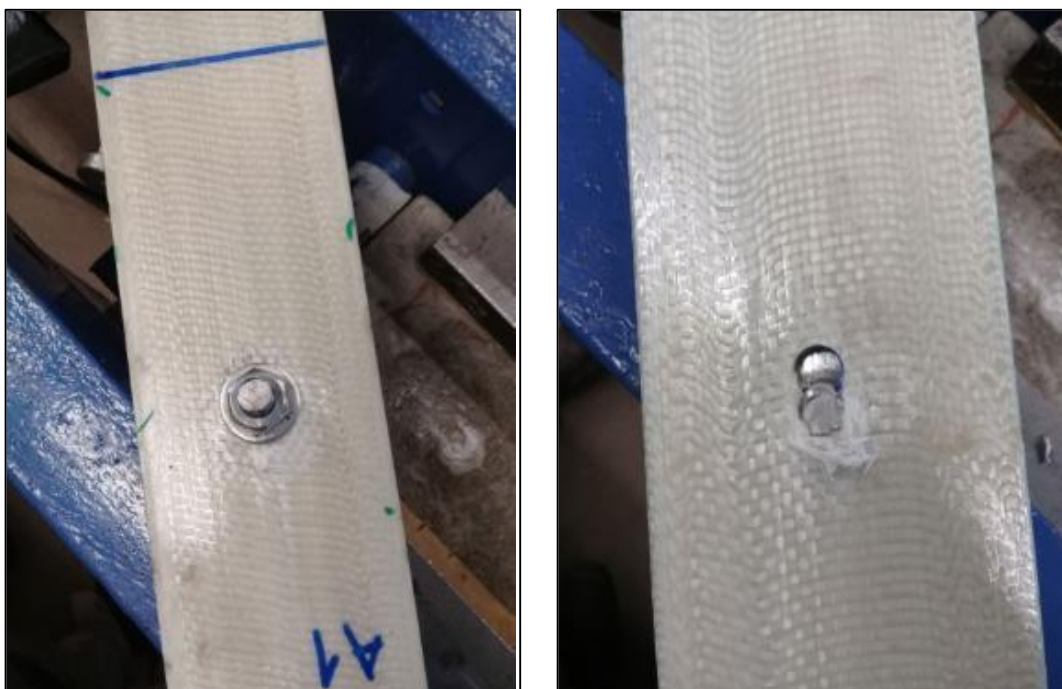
Tipología de falla - Ojalamiento y corte bulón - Probeta A1.
